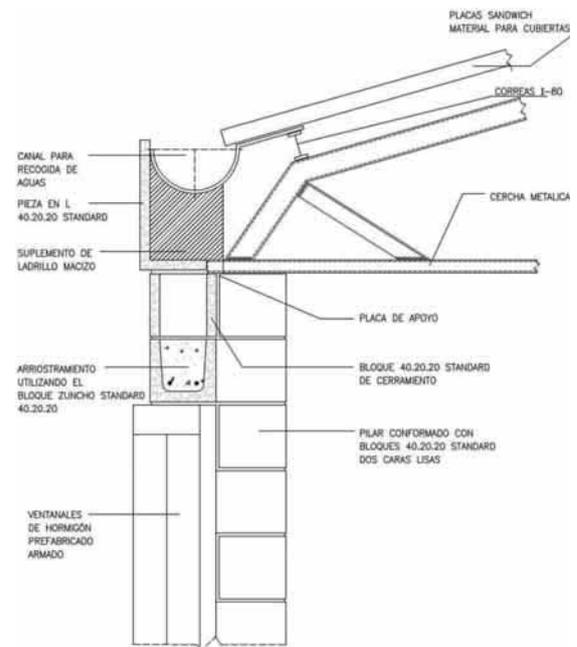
Sección de encuentro de muro de 1 hoja de bloque hueco con cubierta de cercha apoyada en pilastra sobresaliente.
